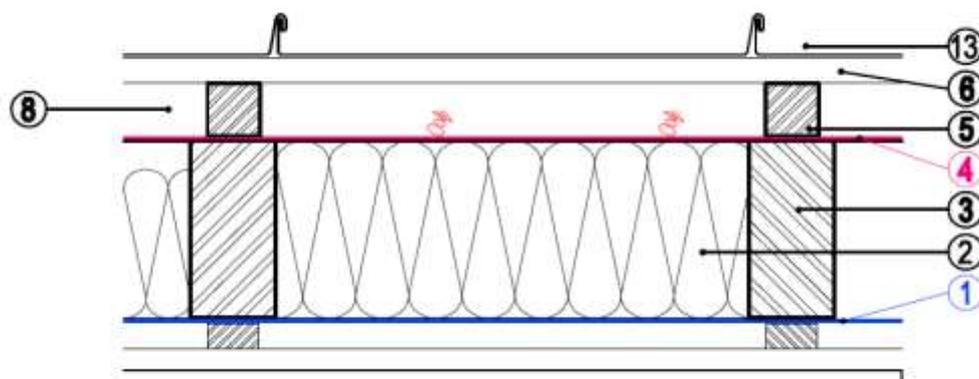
Конструкция крыши с металлической кровлей и диффузионной плёнкой, уложенной на утеплитель. Фальцевая кровля смонтирована на обрешётку / настил.
